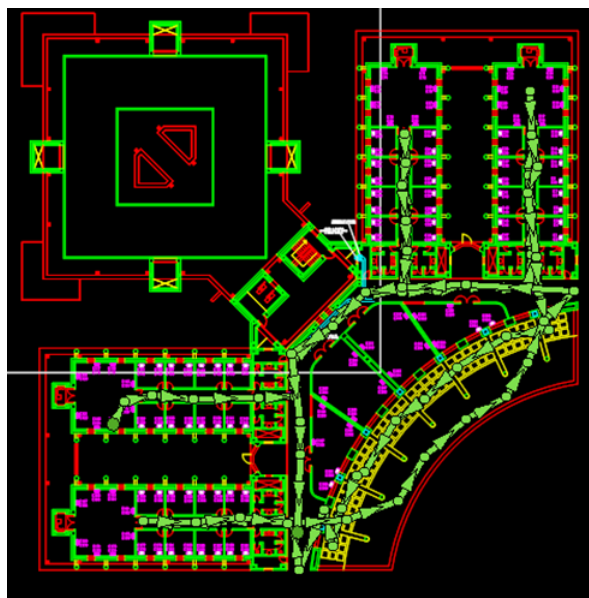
Fase de calibración del Sistema Ekahau en la 3ª planta del Departamento de Electrónica, Edificio Politécnico
